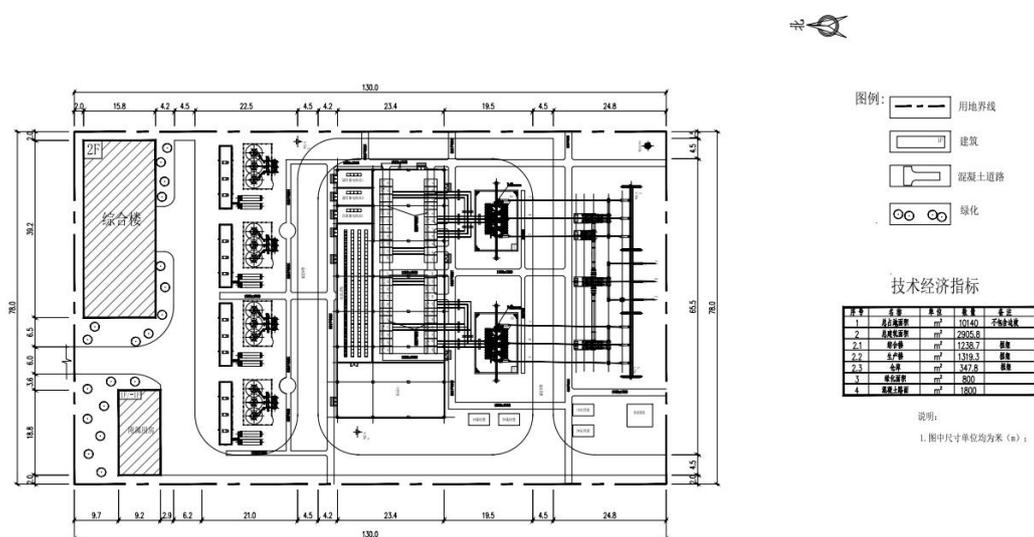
小梨园光伏 220kV 变电站站区总平面图
